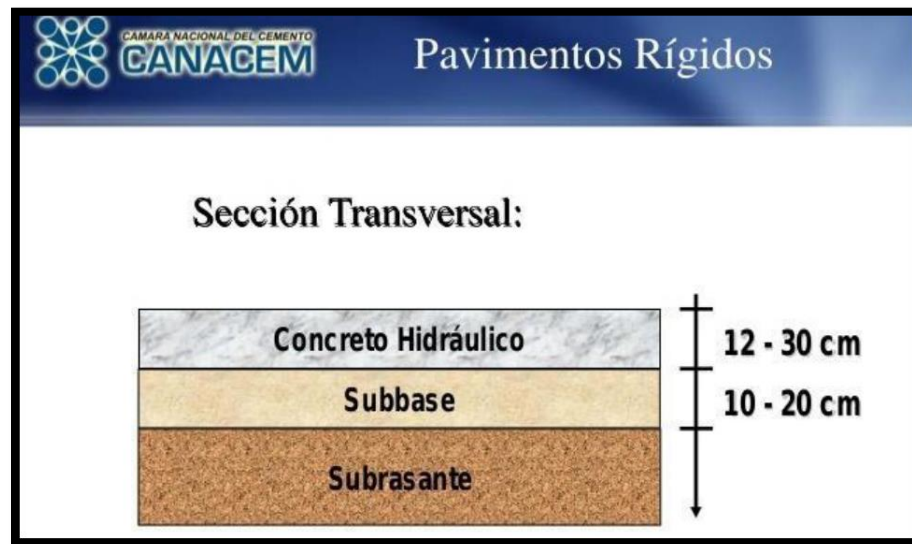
Estructura de pavimento rígido. Fuente: (BARAJAS,BUITRAGO, 2017)
